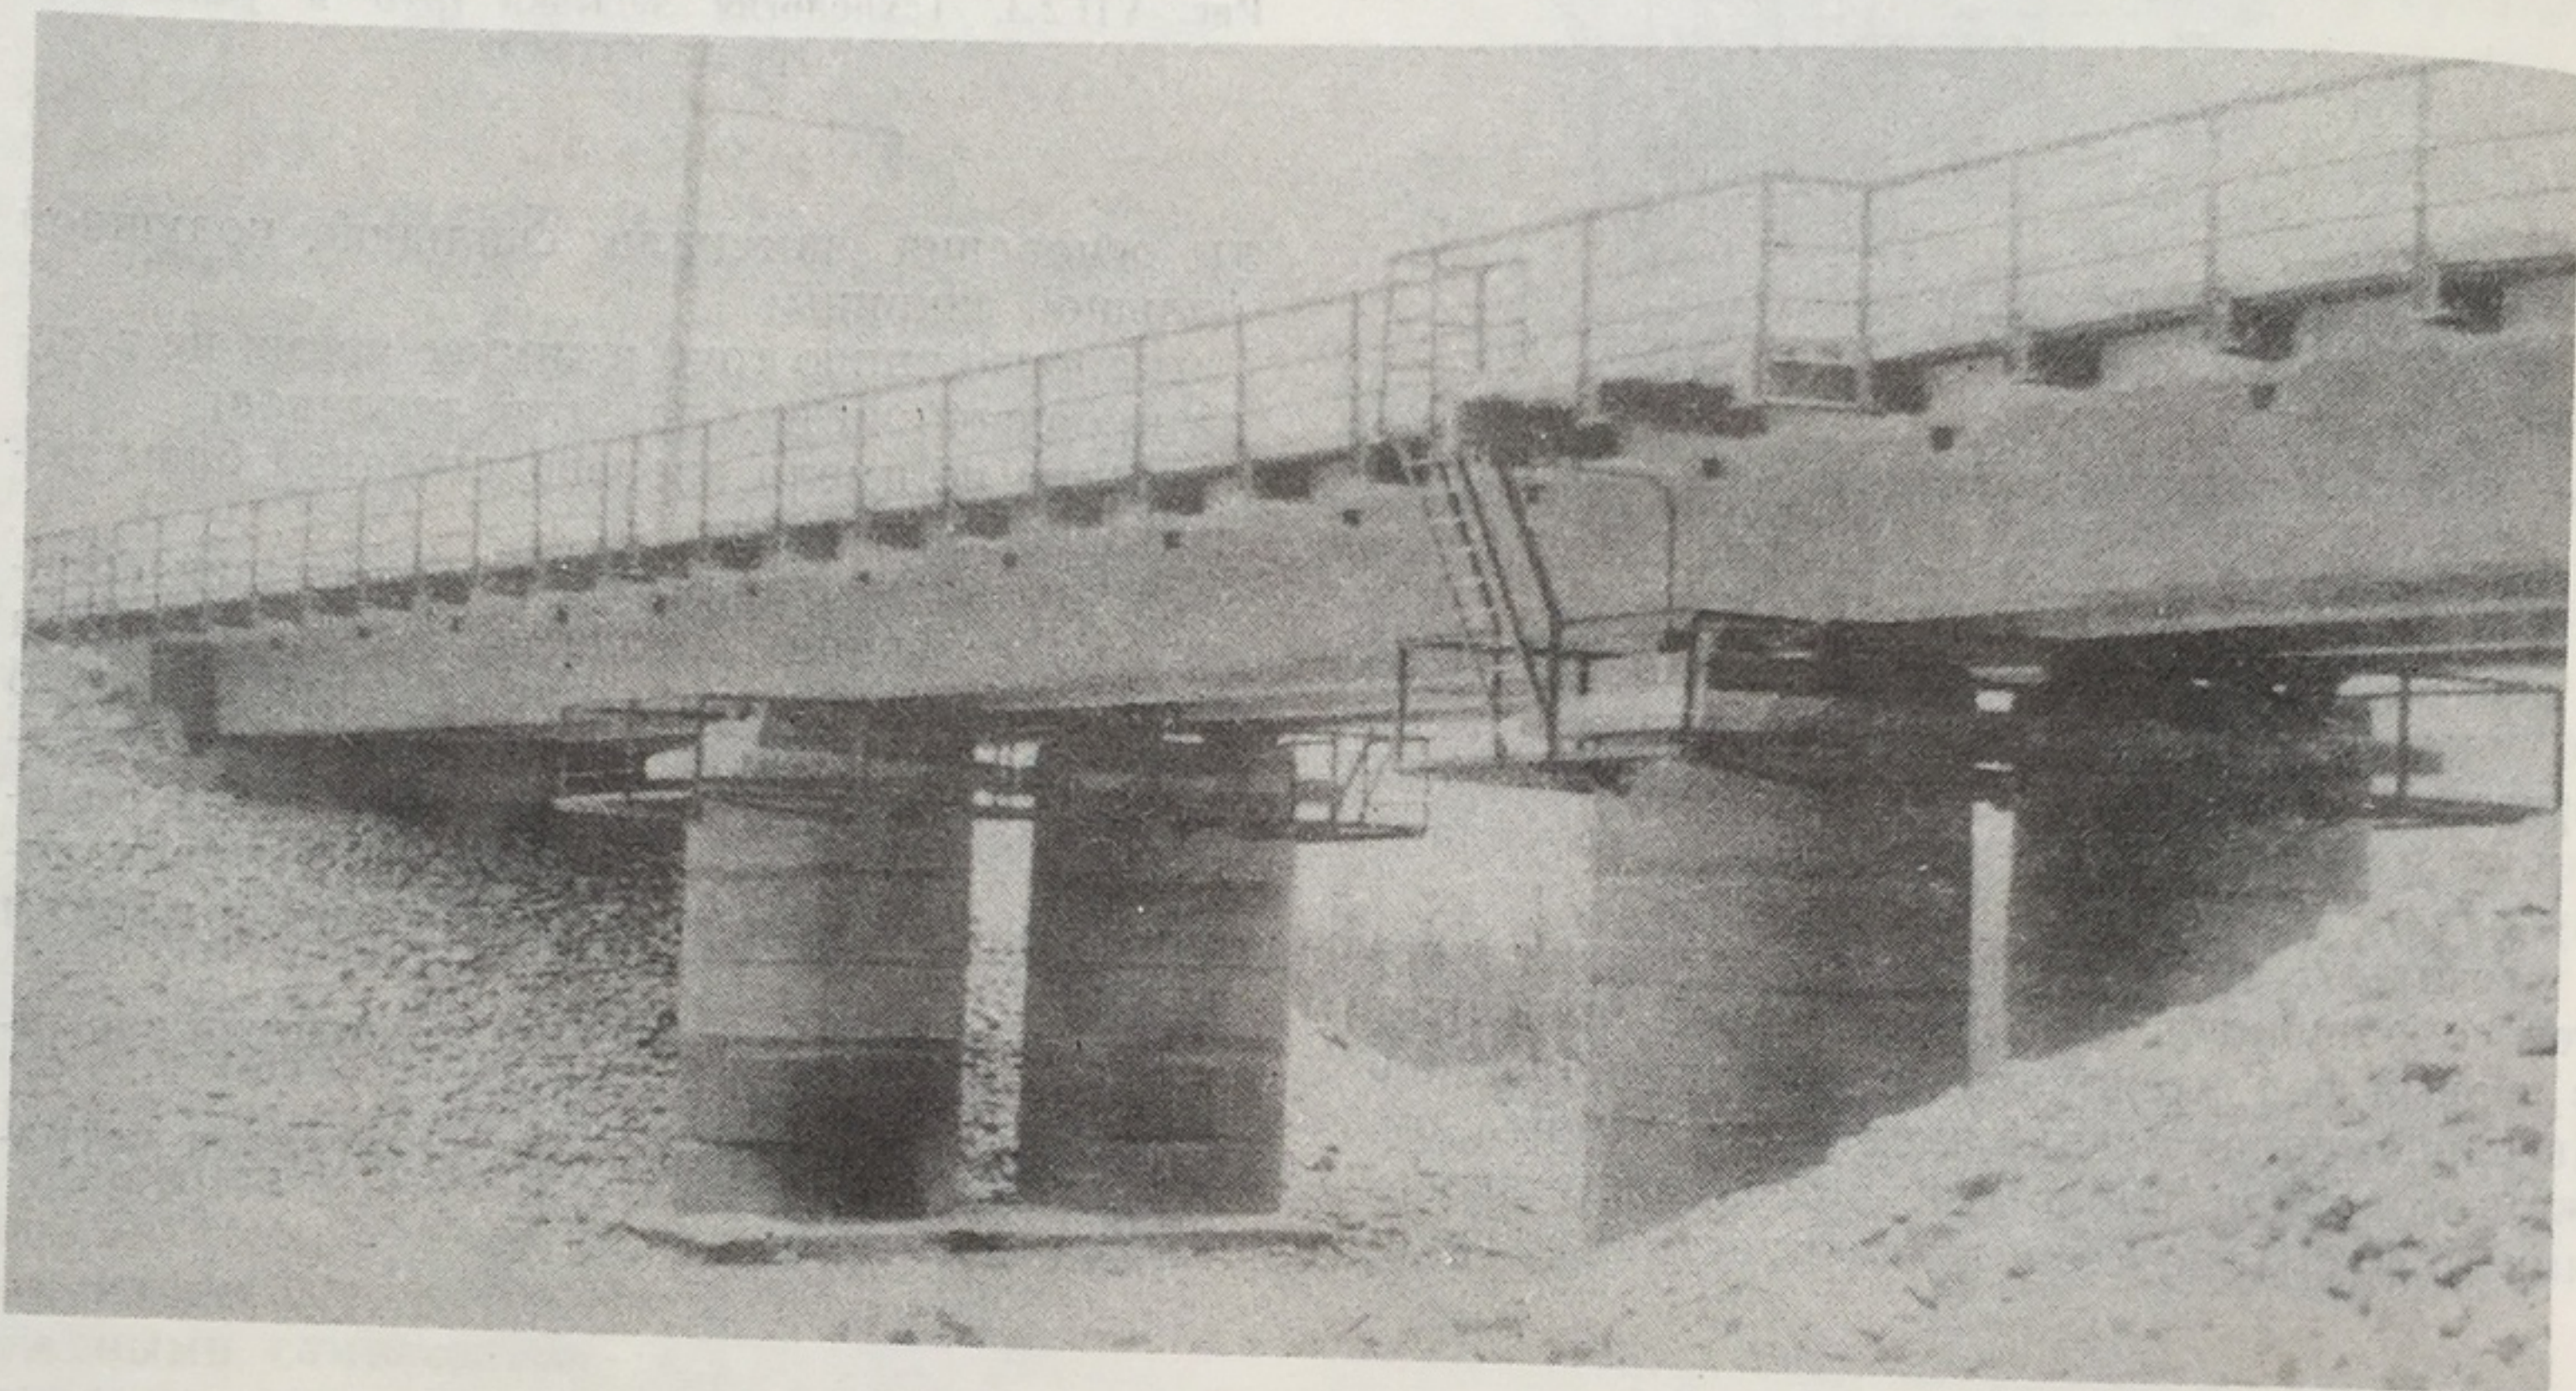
Железобетонный мост на опорах из сборных оболочек
